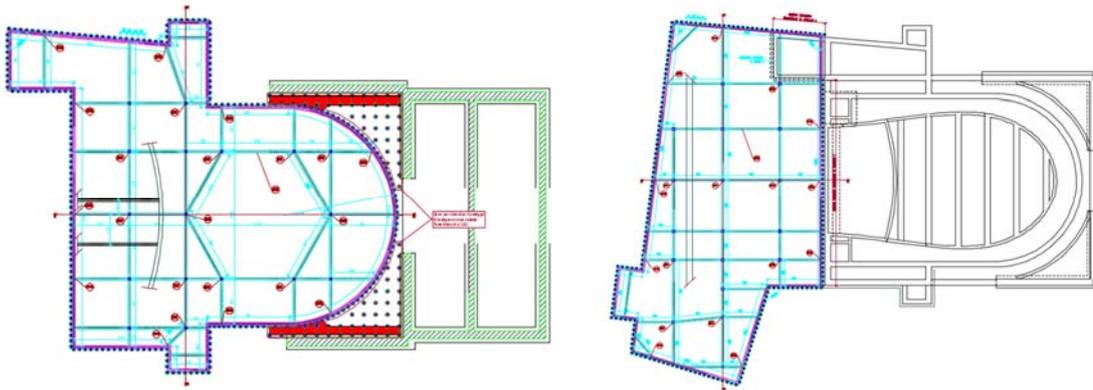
Pianta delle opere provvisorie relative al primo stralcio (a sinistra) e al secondo stralcio (a destra)
